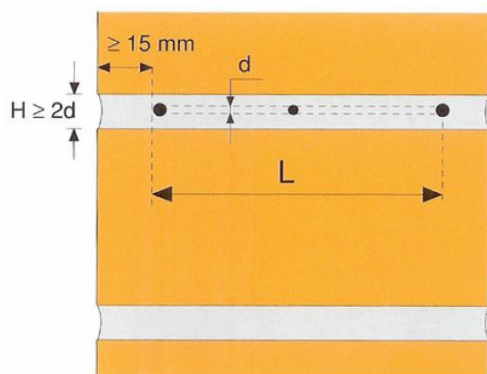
Disposições geométricas da armadura face à espessura da junta [48]
